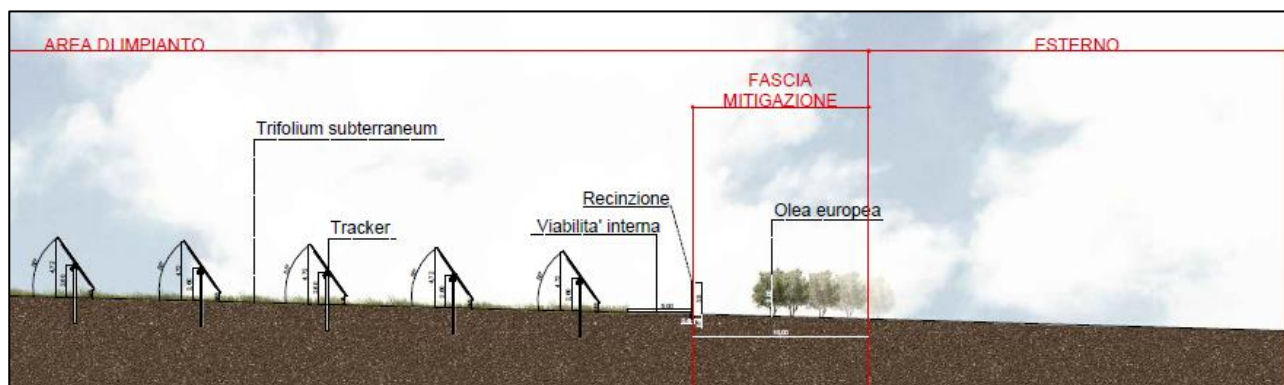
planimetria dell'area di impianto e della fascia di mitigazione.
